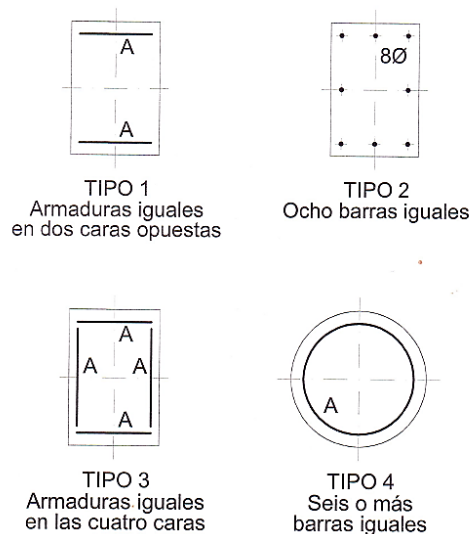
Tipos de armado para soportes (fuente: Jiménez Montoya, 2009)
